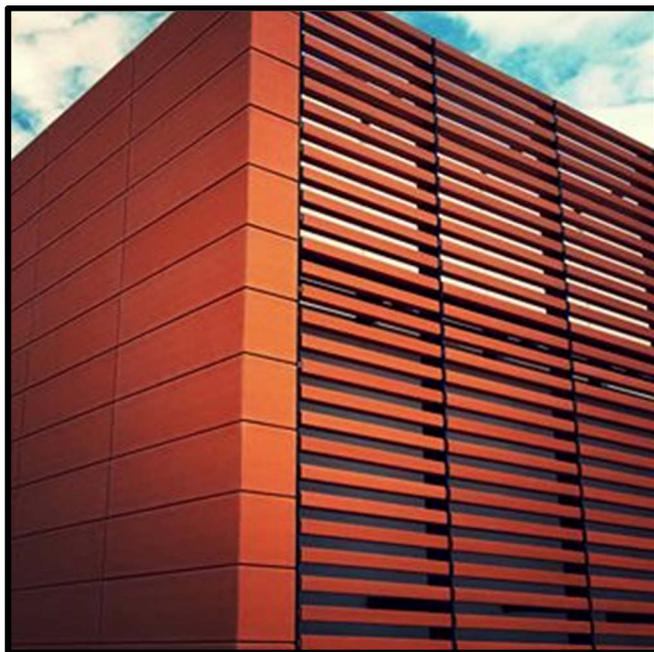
Fachada Ventilafa (Ref. Keragail) com Brise
